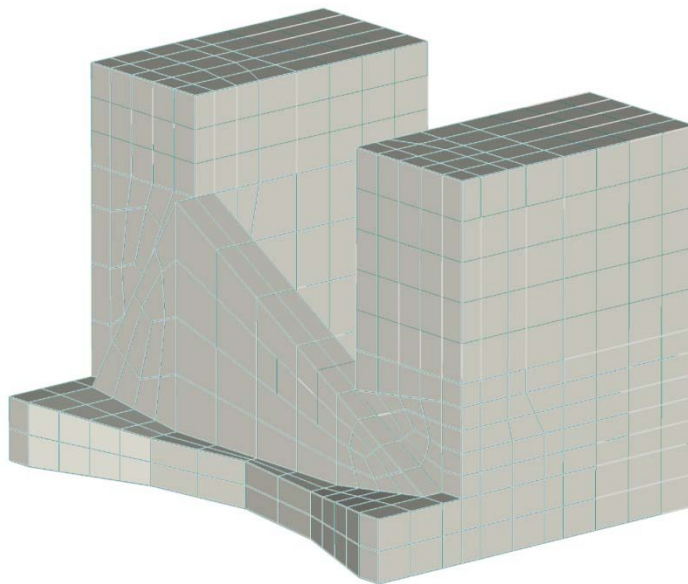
Einbettung des Schubelementes in Normalbeton
